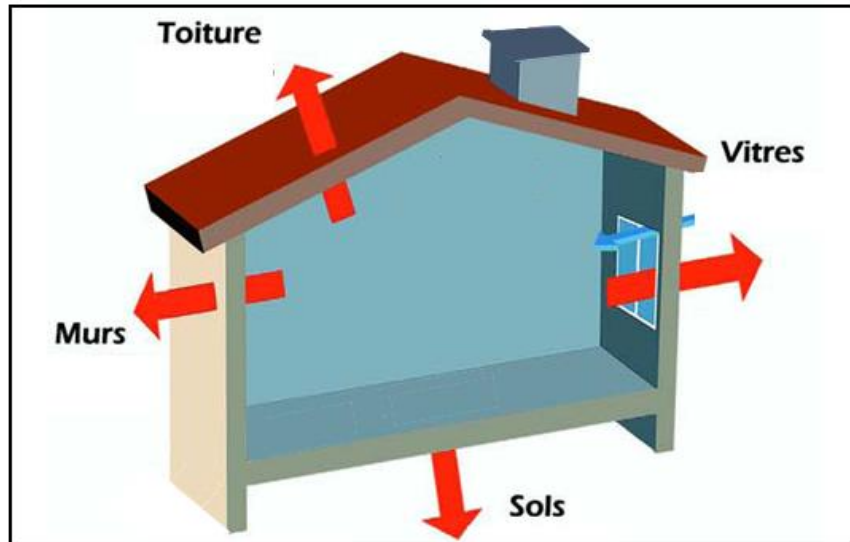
les différentes déperditions thermiques au niveau de l'enveloppe d'une construction. Source : www.ageden38.org
